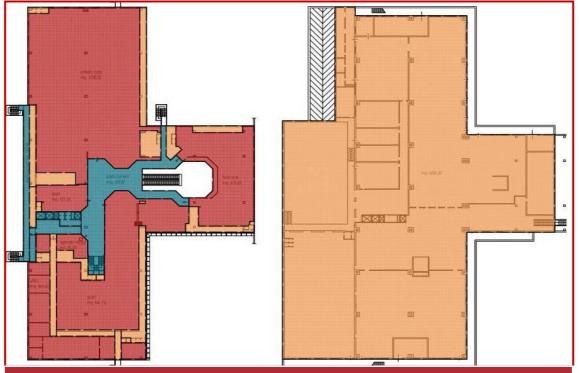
Pianta primo piano (sx) e piano interrato (dx) dell'esercizio commerciale – non in scala
